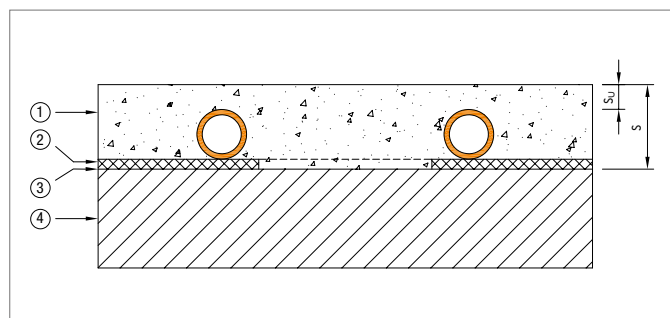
Prinzipaufbau Klettsystem RAUTHERM SPEED plus renova
